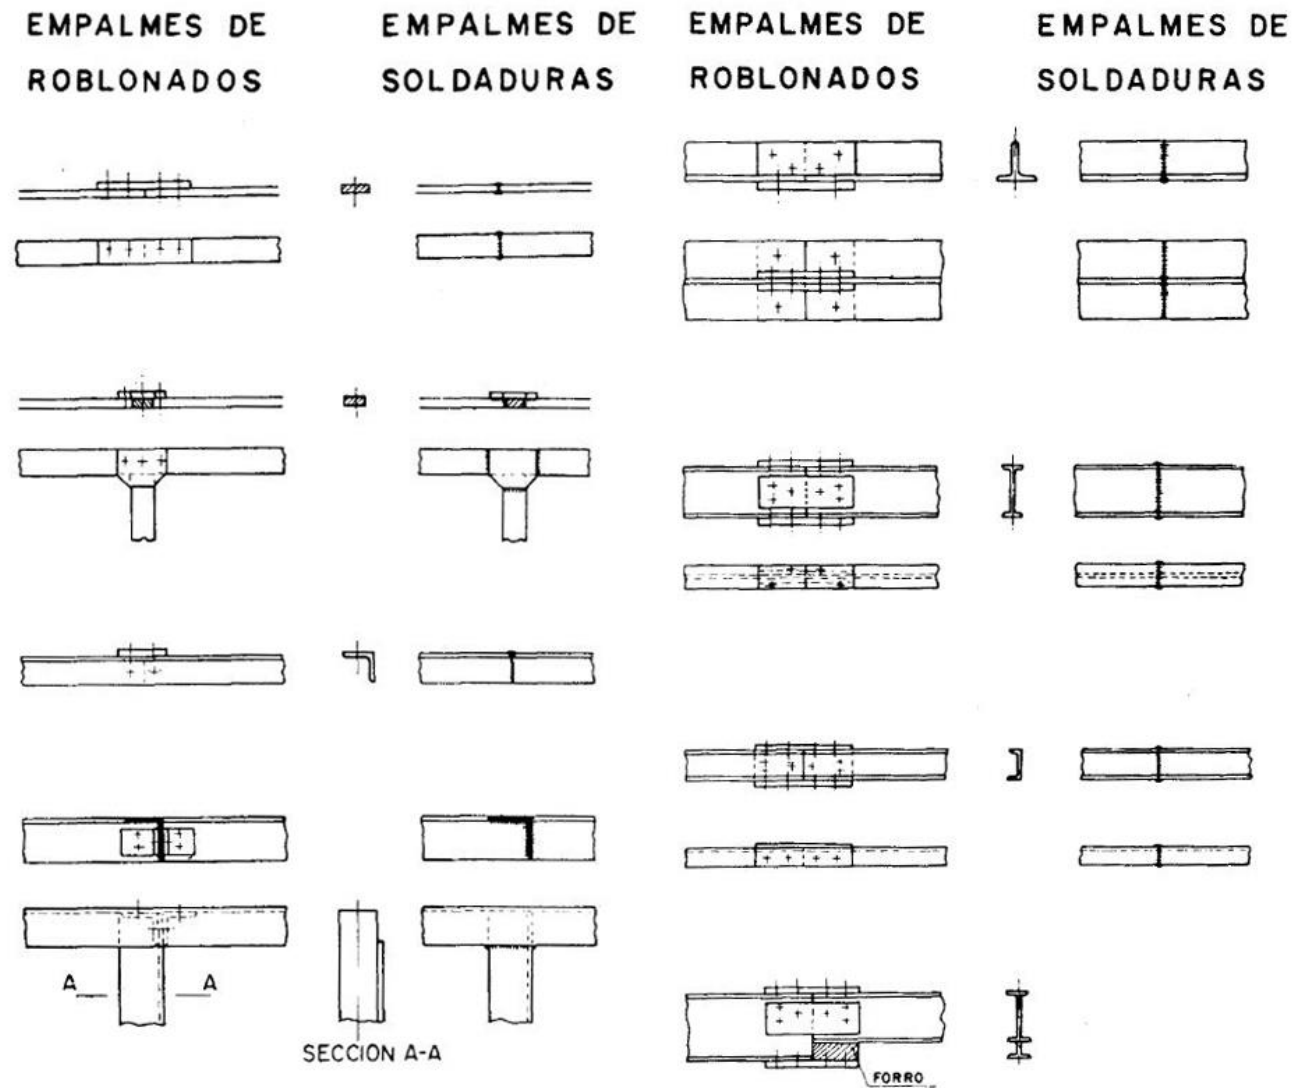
Diferentes uniones de roblones y soldadura
